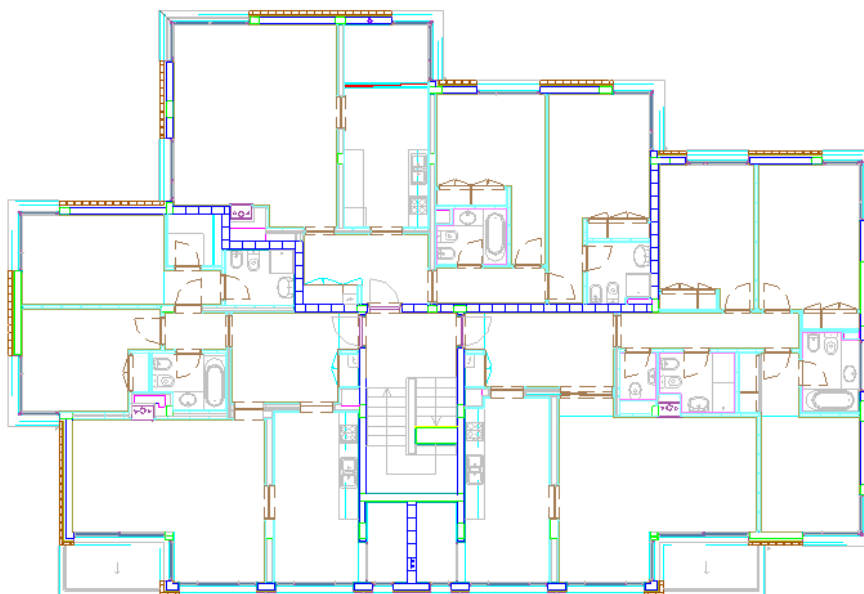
Planta de arquitetura do piso 1 e 2 no *Revit
